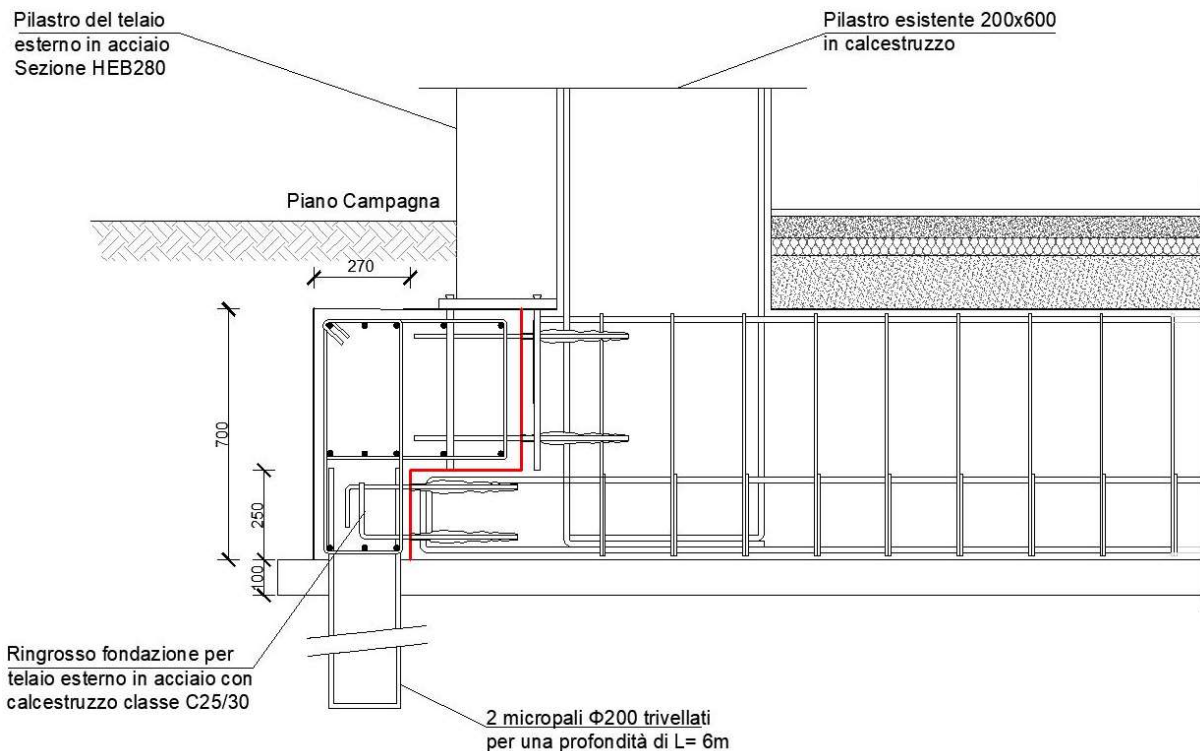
Collegamento delle nuove fondazioni a quelle esistenti.
